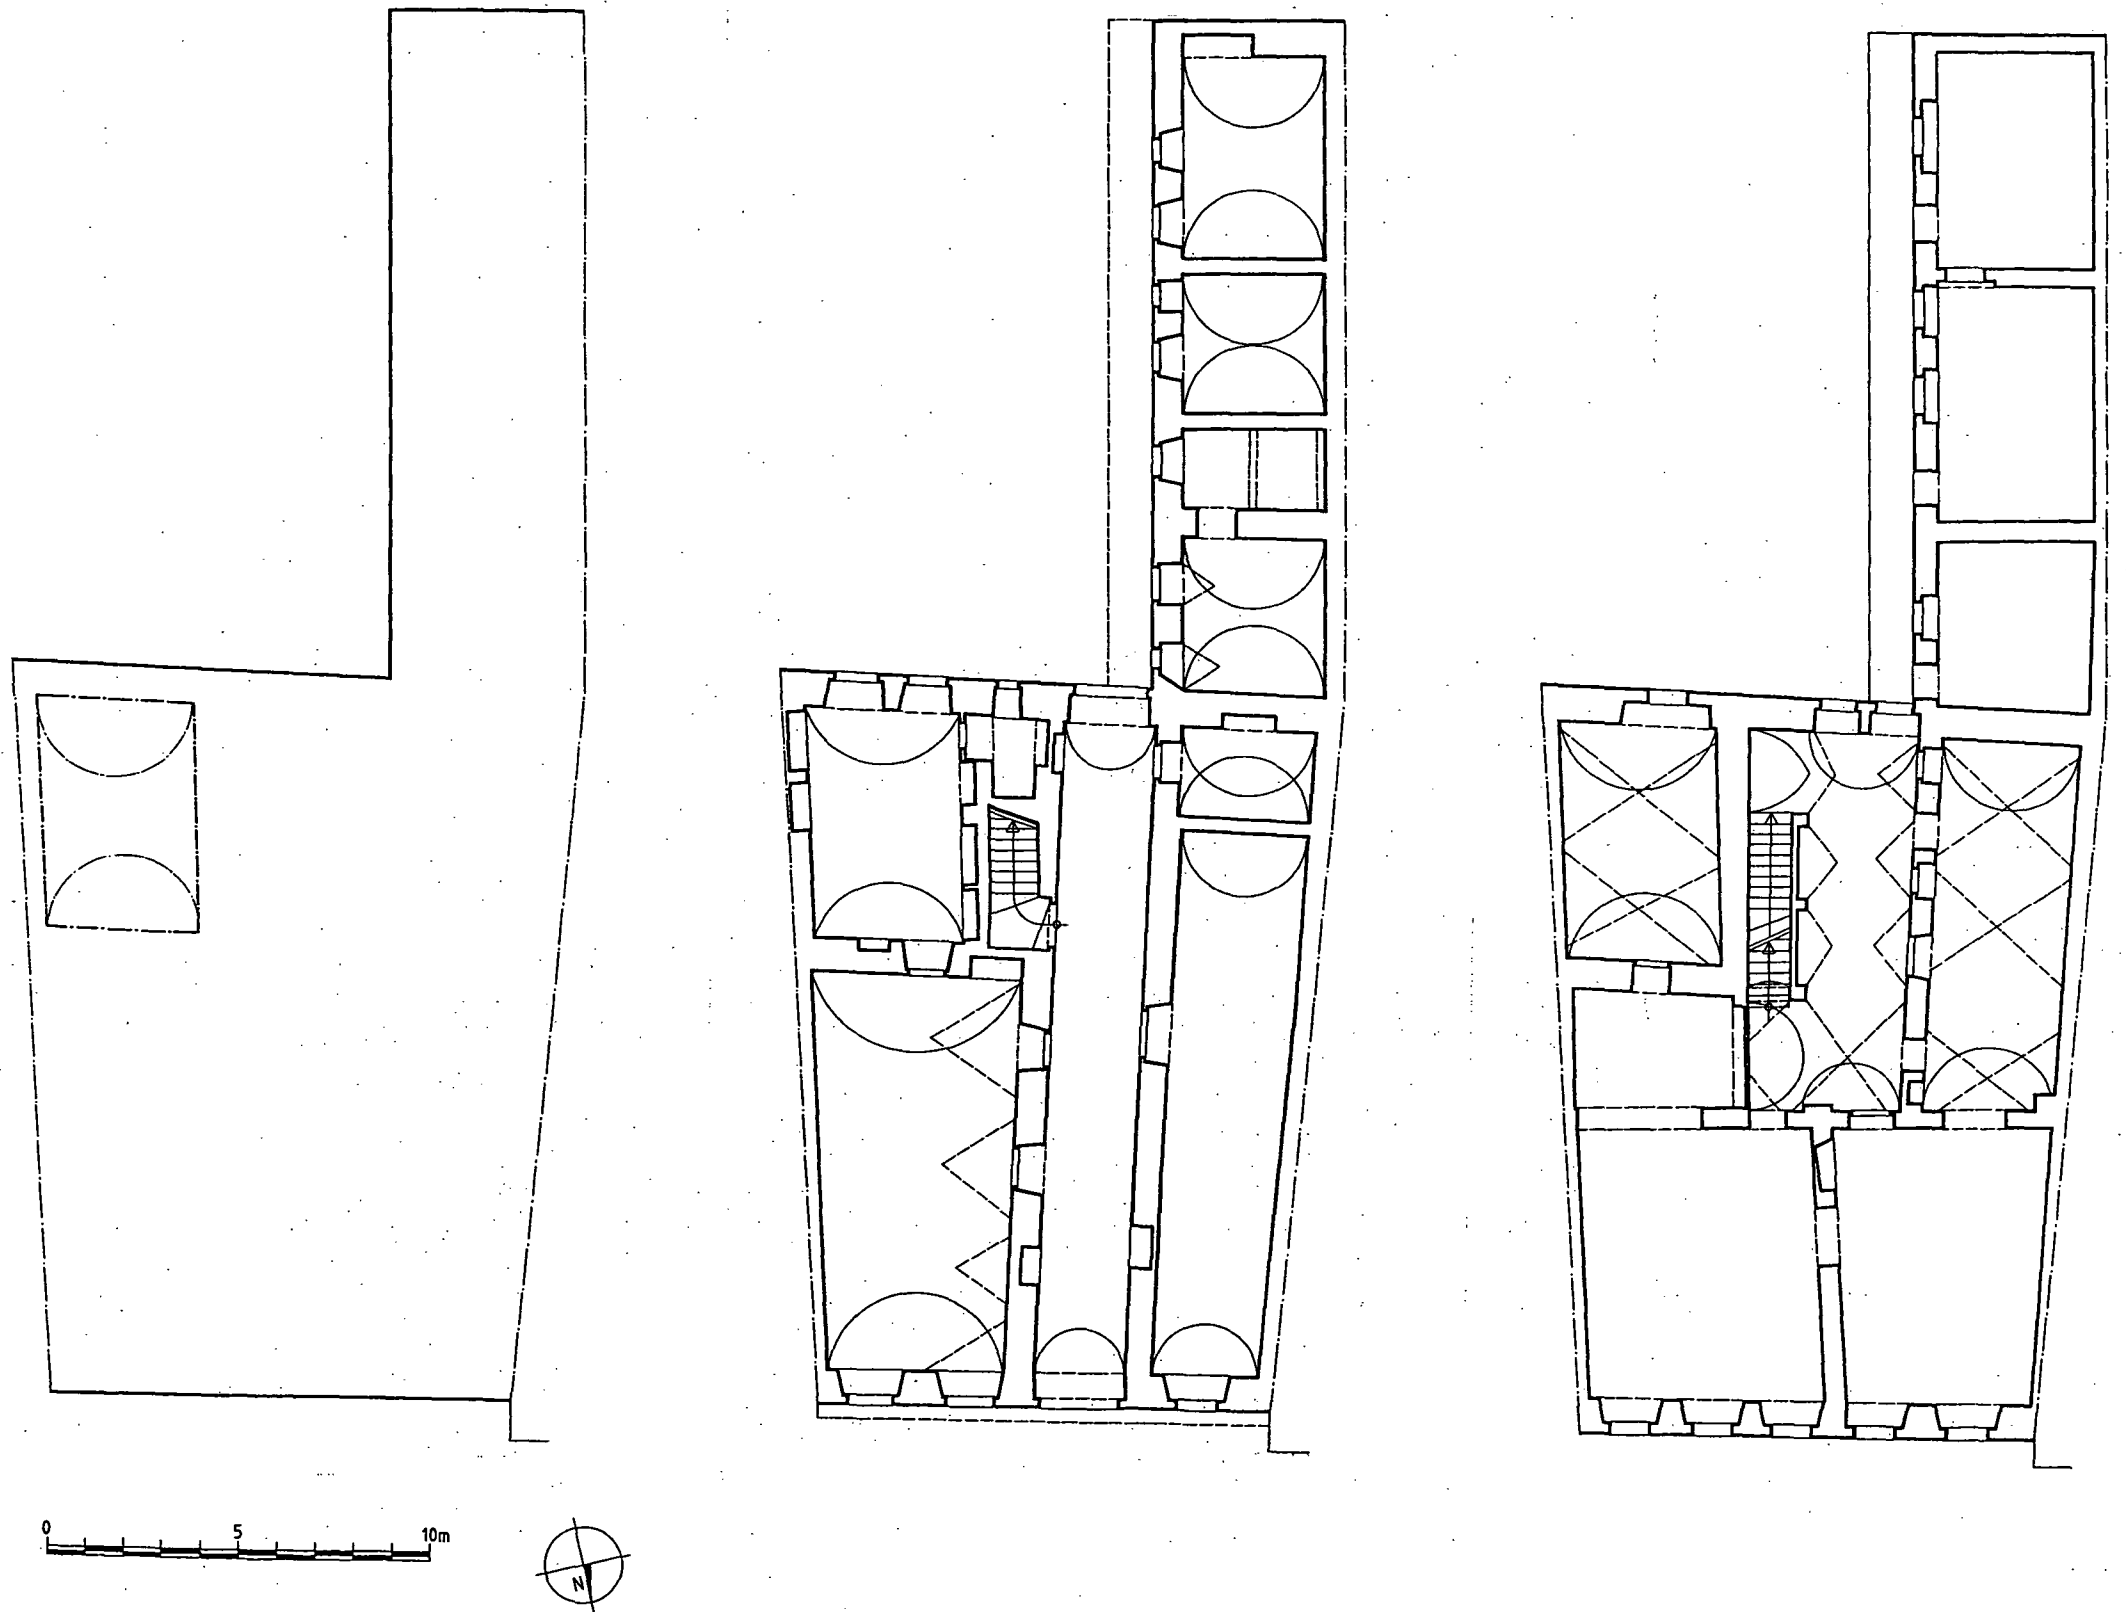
Stadtplatz 20 – Grundrisse Keller, Erdgeschoss, Obergeschoss (1:200).
